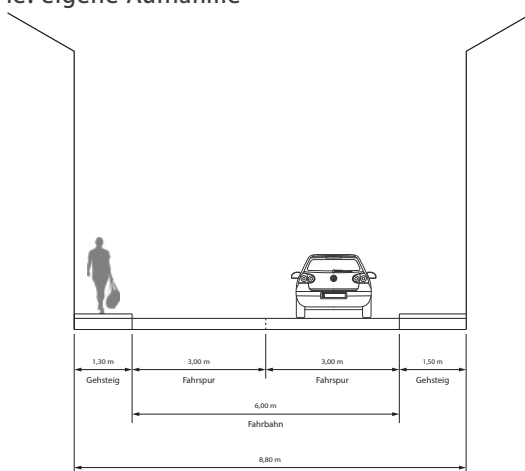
Schnitt Bahnstraße Ecke Hochstraße. Quelle eigene Darstellung
